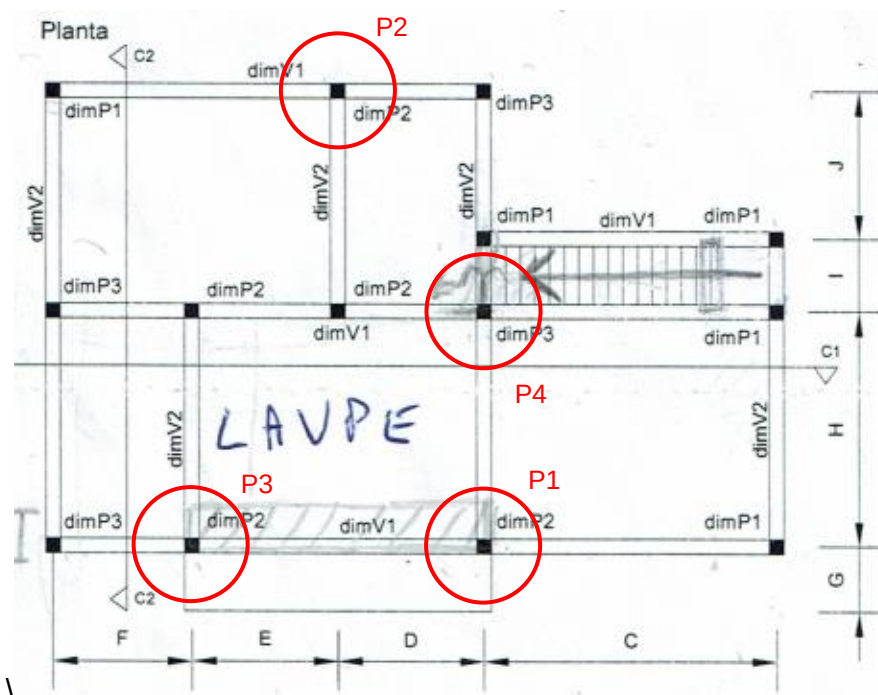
Planta considerada para o confinamento (PEC-2019/2020)
